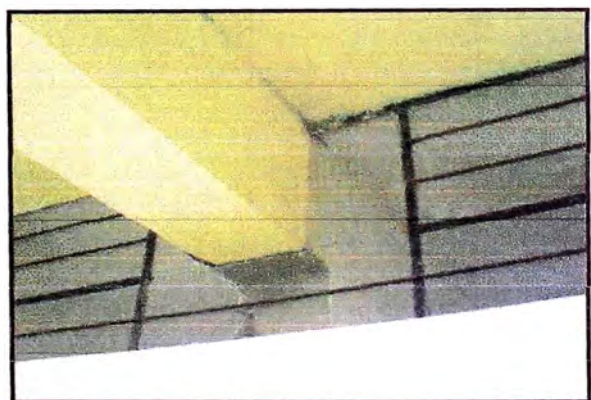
Construcción colapsada en C.P. La Huerta.
